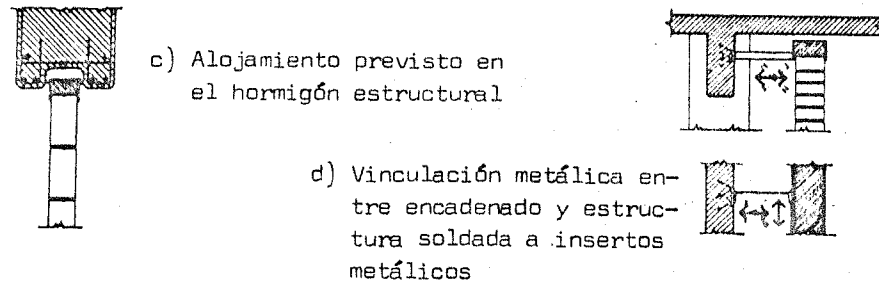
Paneles de mampostería desvinculados de la estructura
